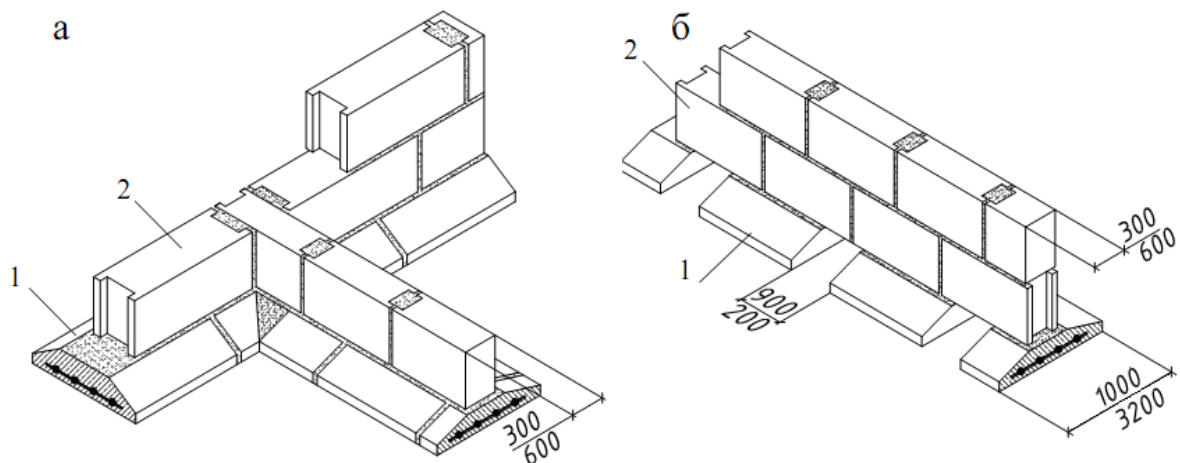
Збірний блоковий стрічковий фундамент із збірних плит і стінових блоків: а – суцільний фундамент; б – переривчастий фундамент; 1 – фундаментні плити; 2 – стінові блоки
